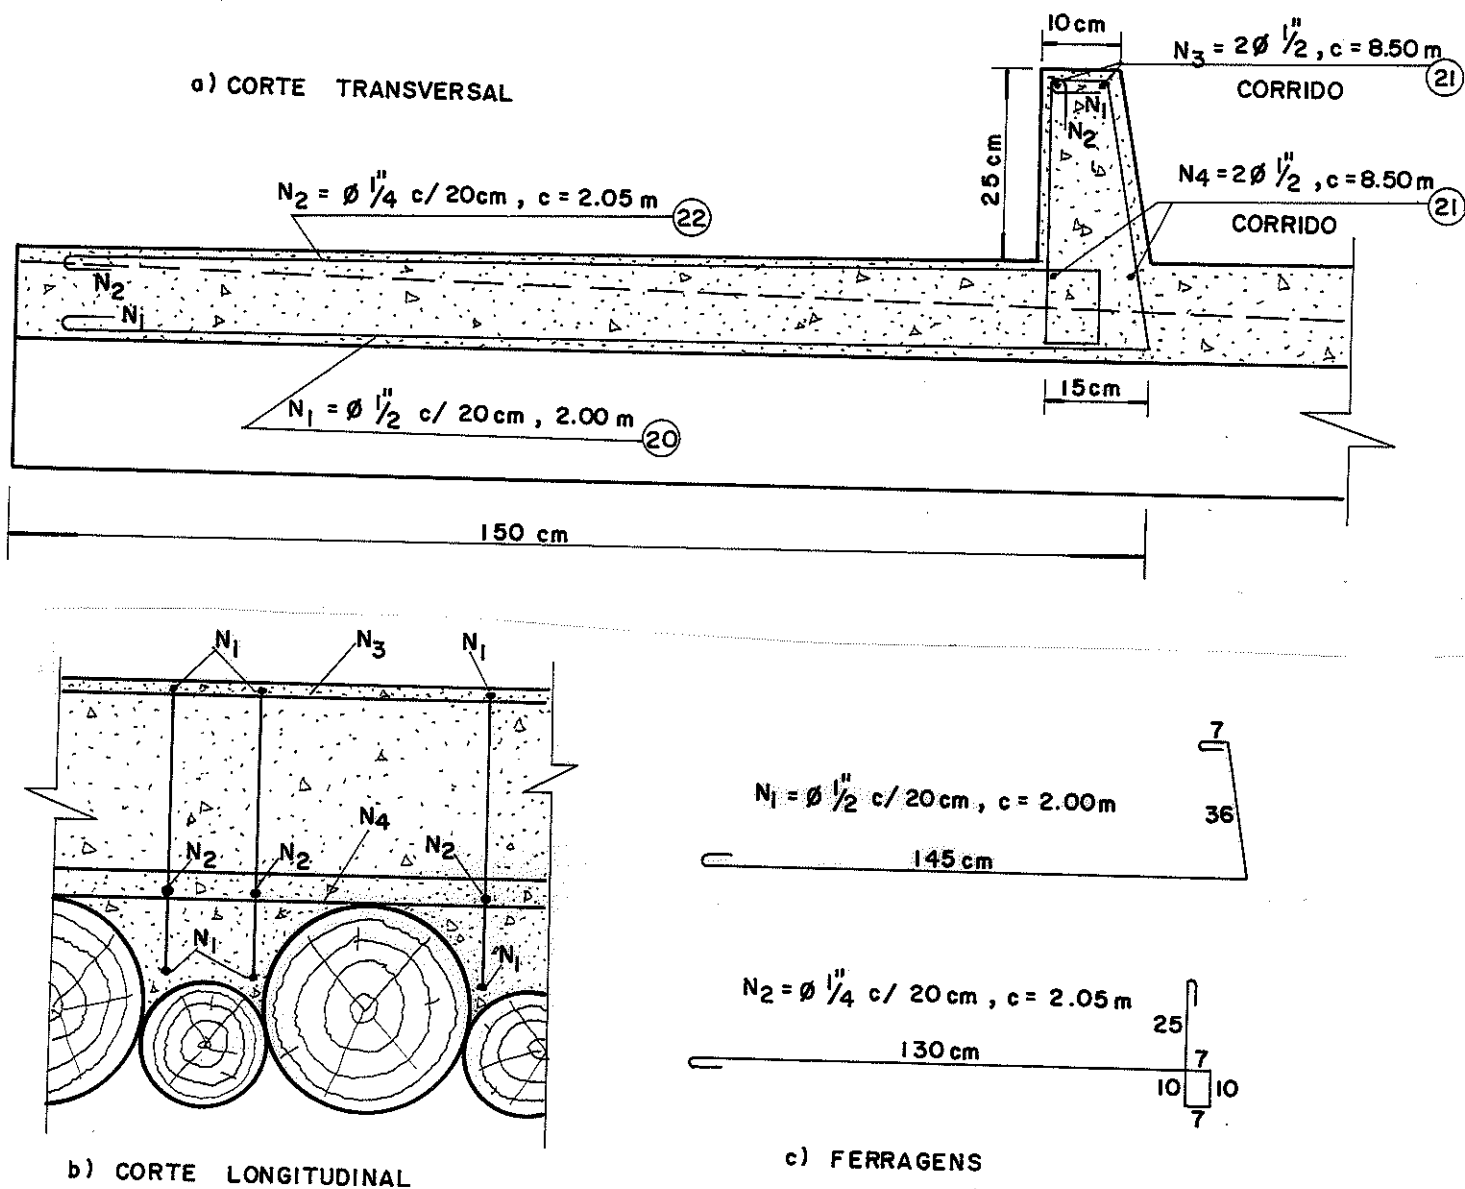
O GUARDA-RODAS, DIMENSÕES E FERRAGENS
